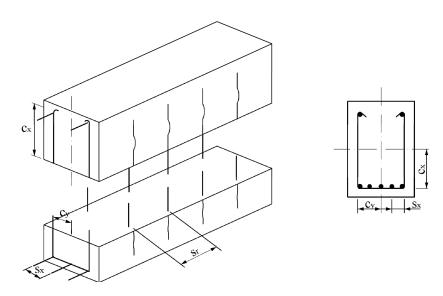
К определению расчетных параметров при вычислении расстояния между наклонными трещинами
